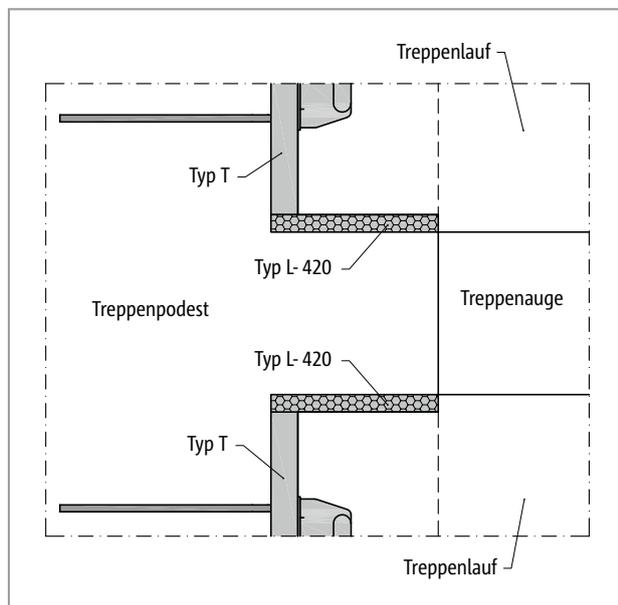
Schöck Tronsole® Typ T: Elementanordnung Detail A
